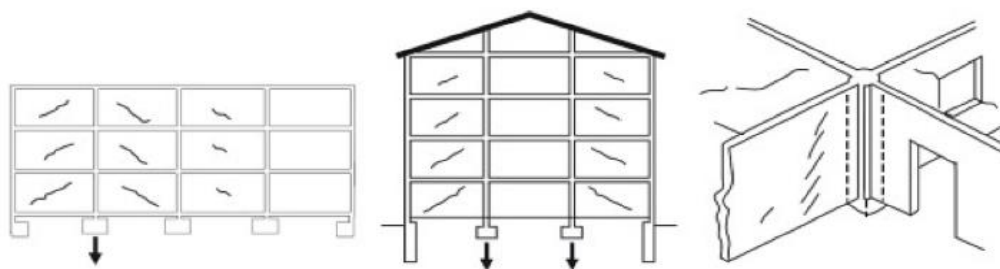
Fissuras típicas causadas por recalque de fundações dos pilares centrais. (Fonte: Ortiz, 1984)
